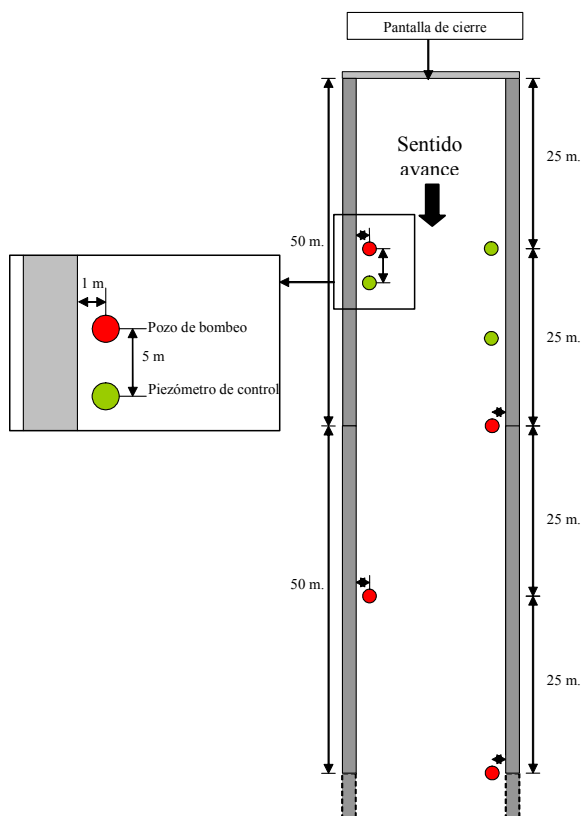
Esquema en planta de la ubicación de los pozos de bombeo (en rojo) y de los piezómetros de control (verde).
